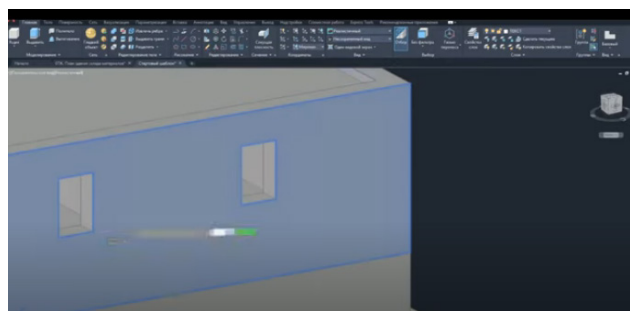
Побудована 3-D конструкція будівлі із заповненими стінами та вікнами
